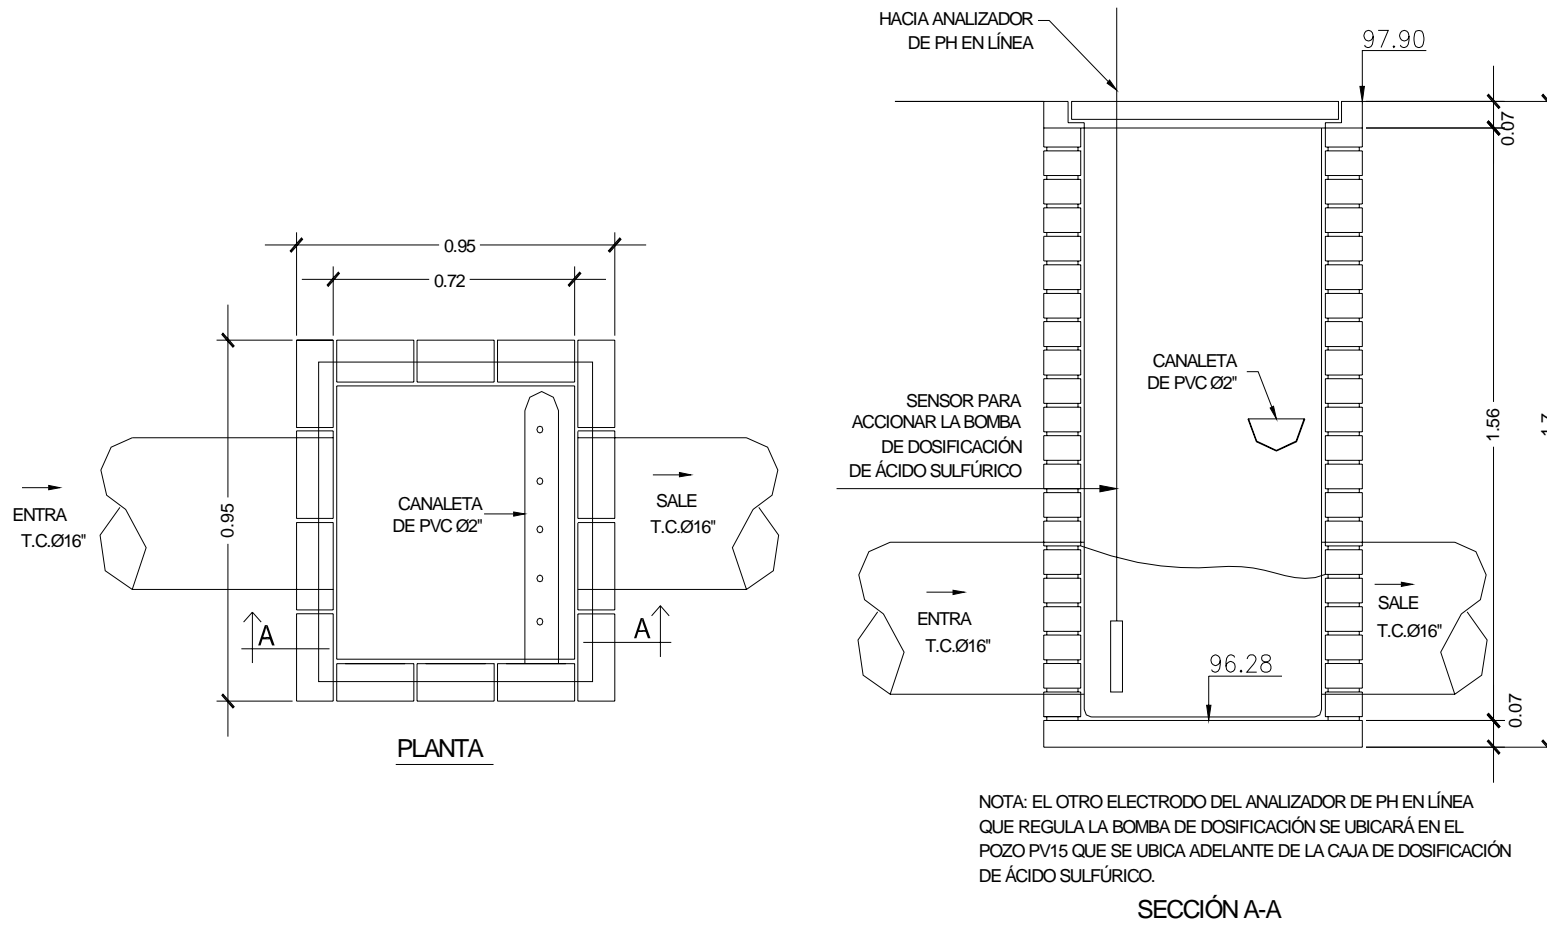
Planta y sección de caja de registro por construir para realizar el pretratamiento de estabilización de pH en las aguas provenientes de lavandería
